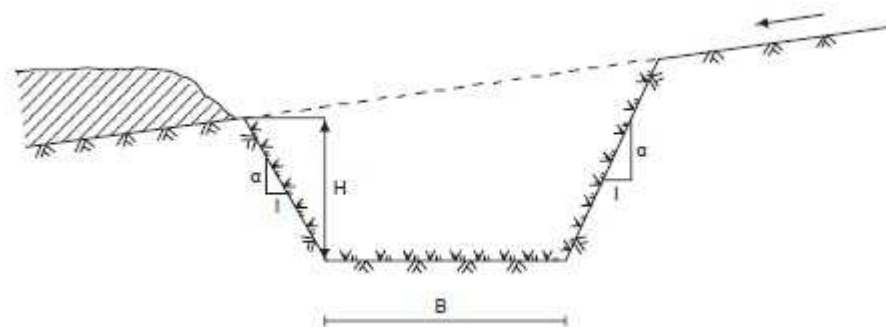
Valeta de proteção de corte de seção trapezoidal (FONTE: DNIT, 2006).
